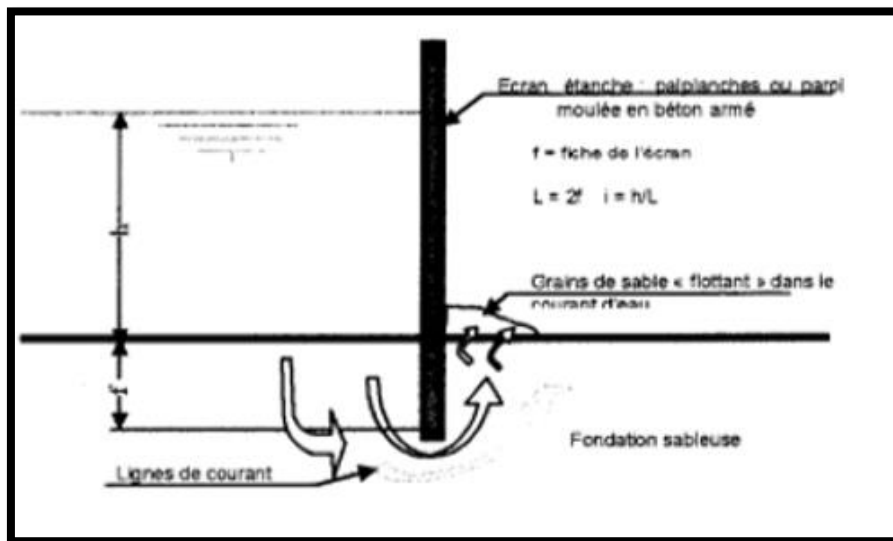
Développement d'un phénomène de boulangerie sous un rideau de palplanches (33)
